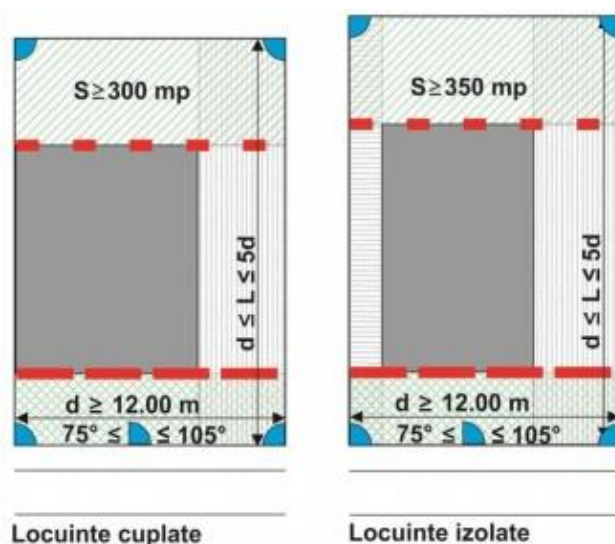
Ilustrare condițiilor minime de parcelare
